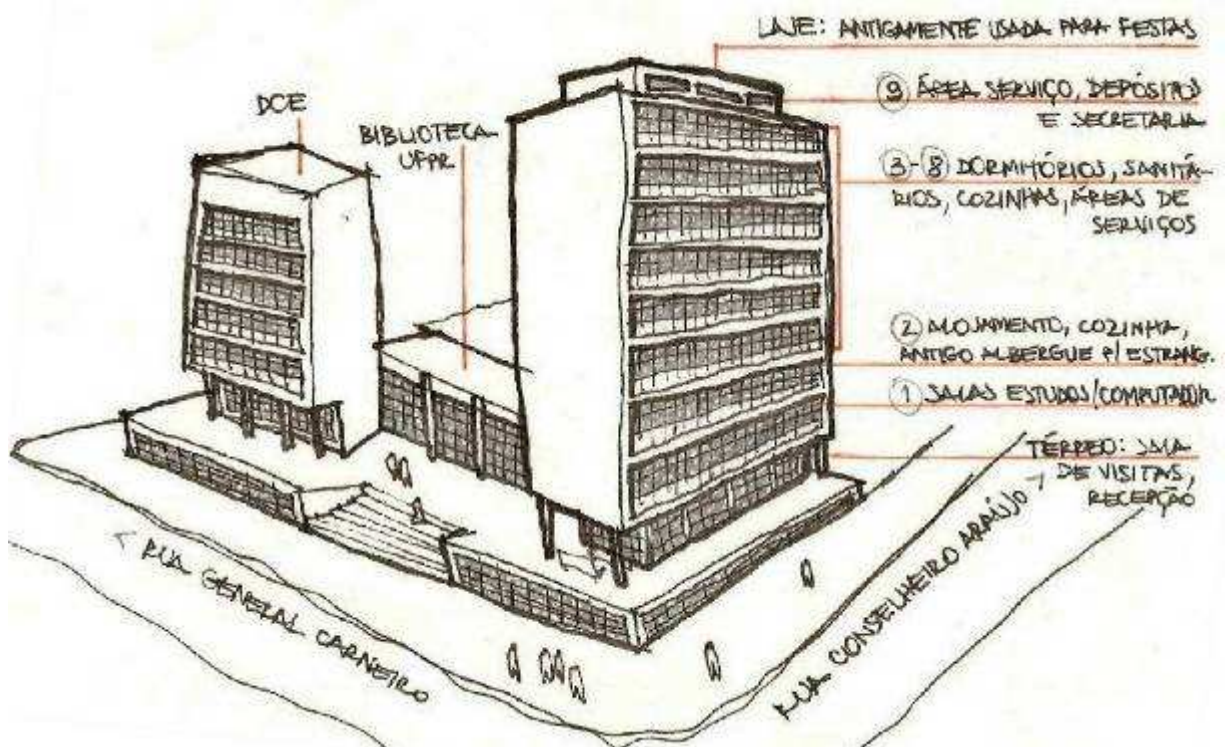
Croqui perspectivado demonstrando a distribuição dos usos nos pavimentos do edifício. (FONTE: A autora, 2009)
